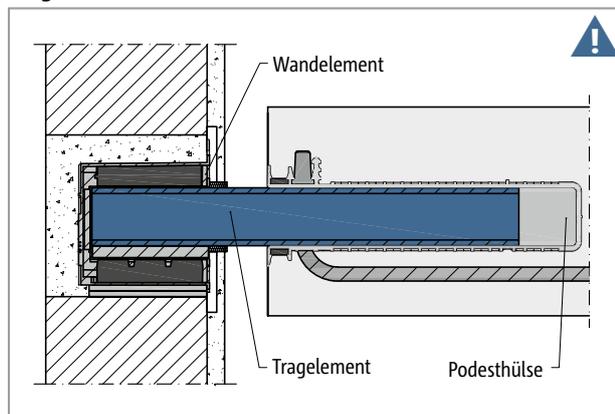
Schöck Tronsole® Typ P: Mehrteiliges Produkt (Wandelement, Tragelement, Podesthülse); Tragelement (eingefärbt) muss auf der Baustelle eingebaut werden.
